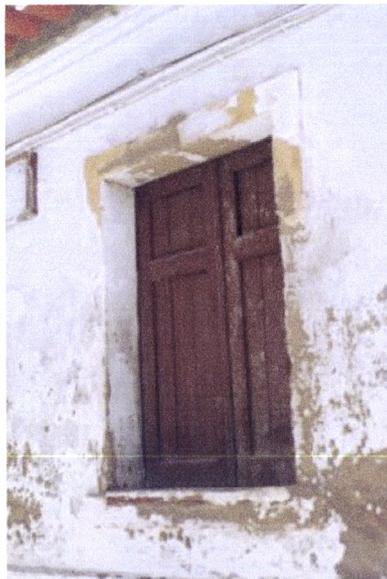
Moura, Bairro da Mouraria, casa em estado evolutivo de degradação (foto da autora)
